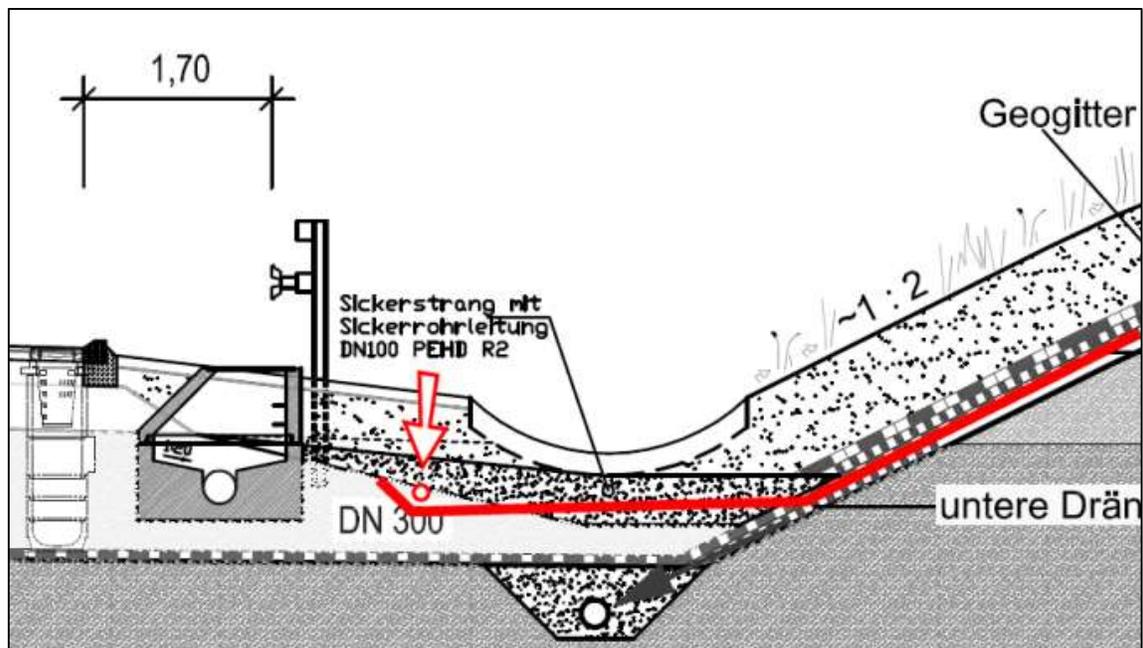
Prinzipskizze zu Drainage und Abdichtung im Einschnittsbereich (Unterlage 1, Kap. 4.4.3)
